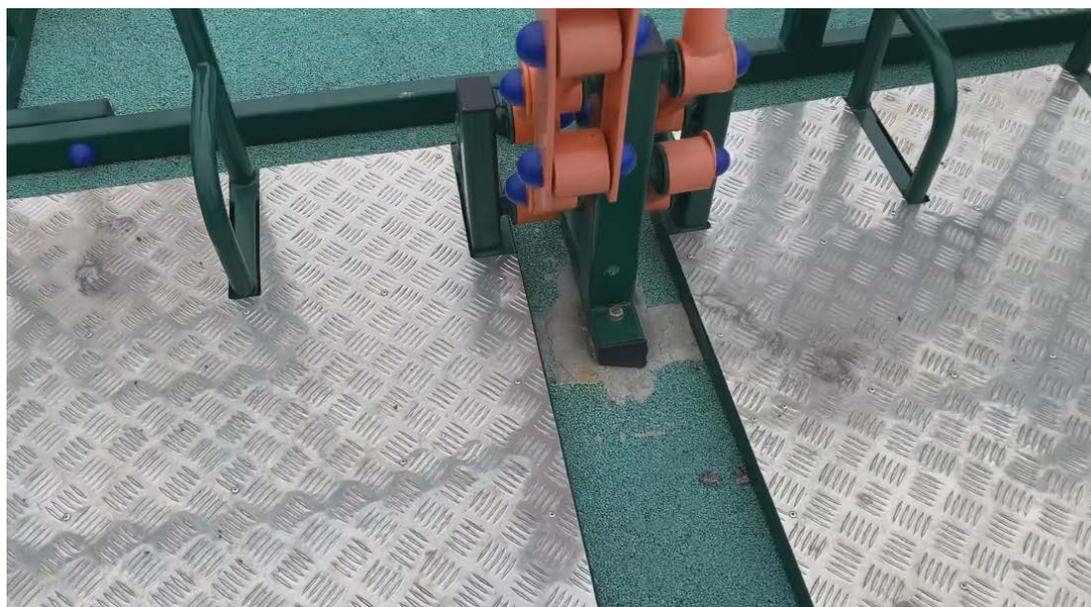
Крепление опорной конструкция тренажерного комплекса к закладным деталям фундамента смонтированного на площадке №2 у тренажера рули. Места примыкания универсального покрытия к блоку фундамента залиты цементным раствором поверх универсального покрытия, на поверхности универсального покрытия видны темные пятна.
